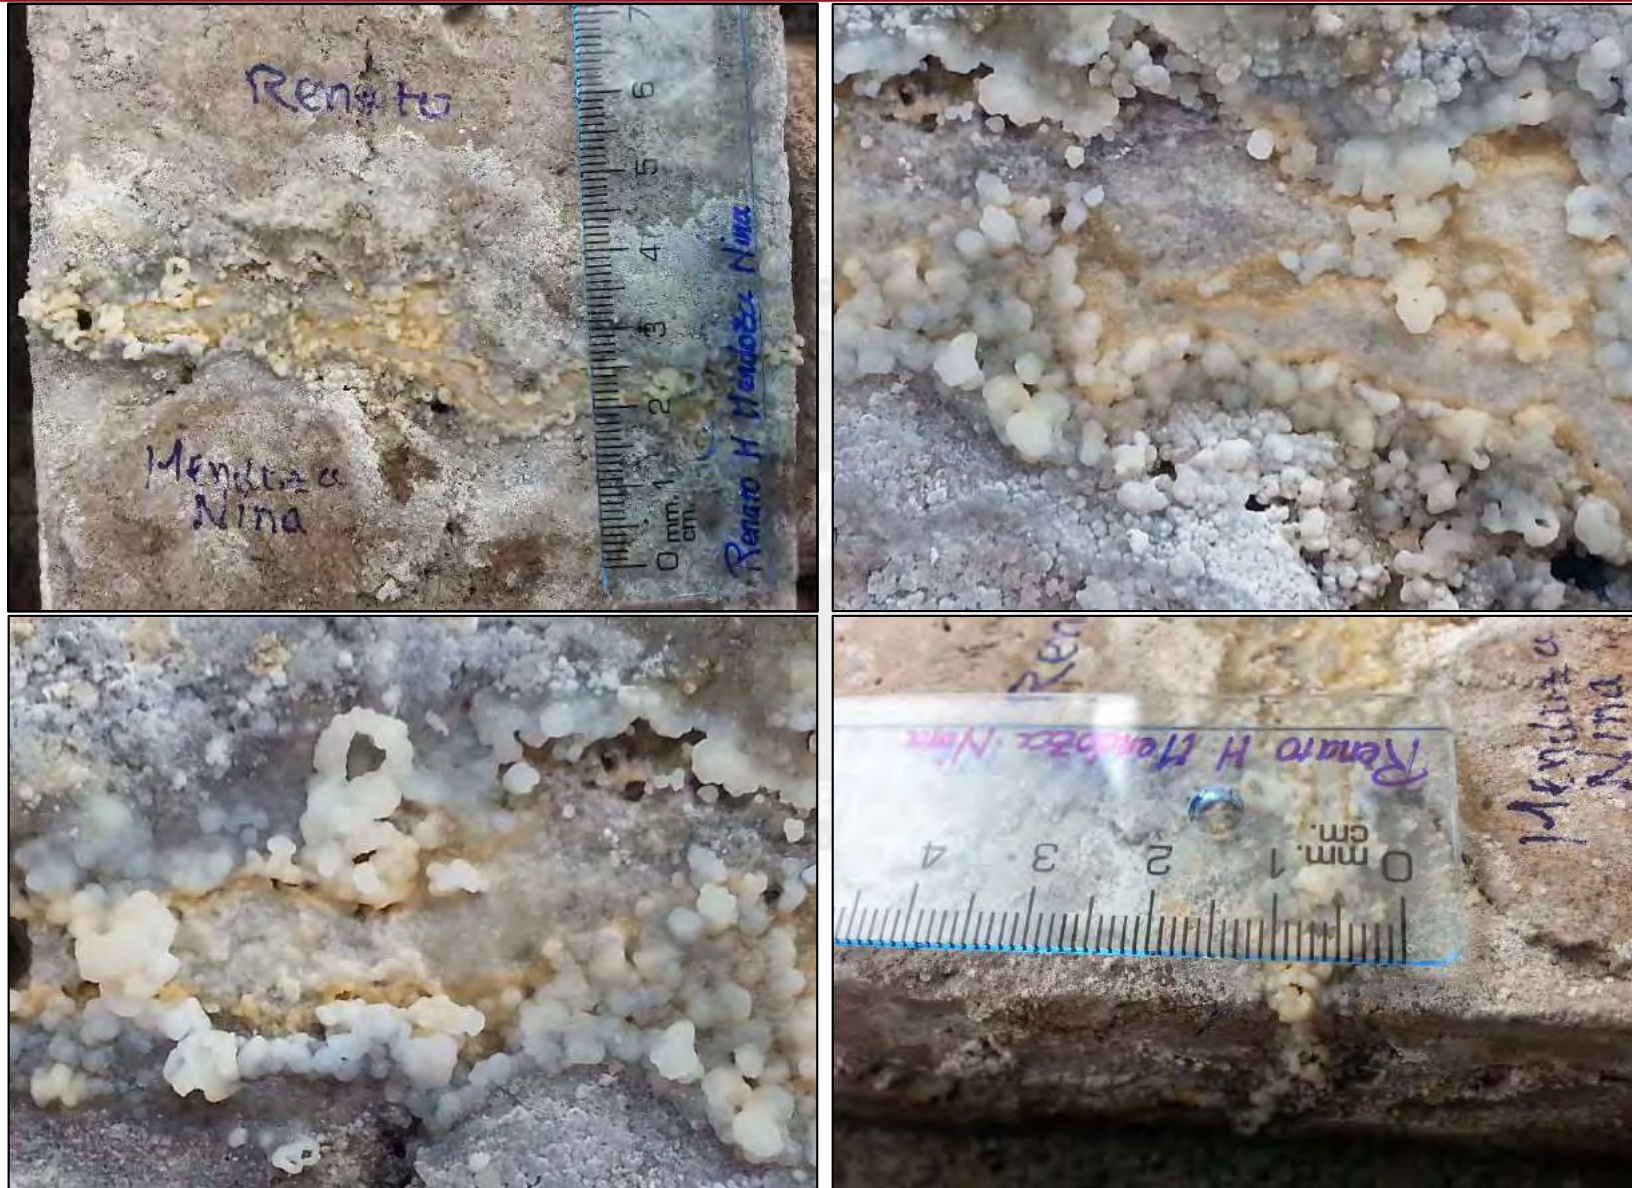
Bioreparación de fisuras (self healing concrete by use of bacteria to repair cracks in concrete).
